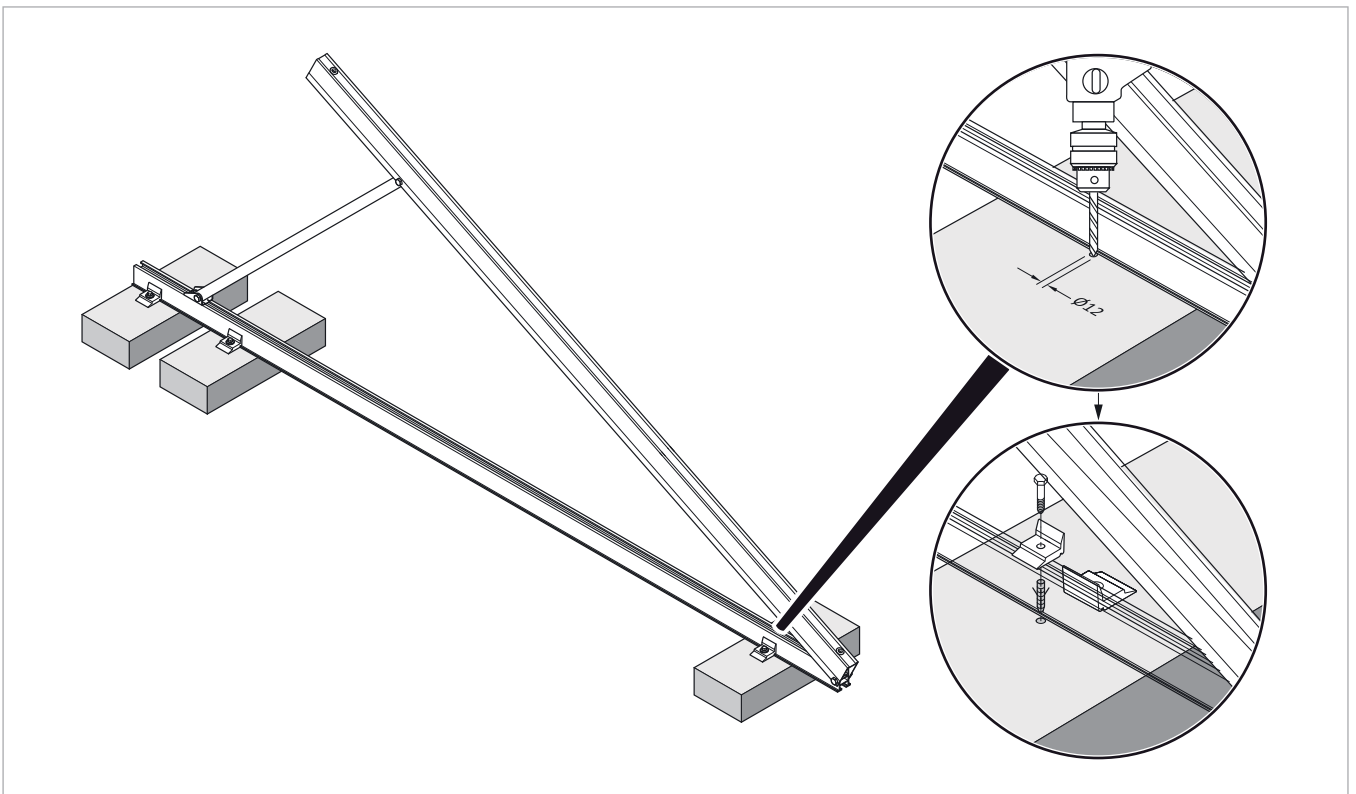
Montaje del soporte para tejado plano en piedra de hormigón
